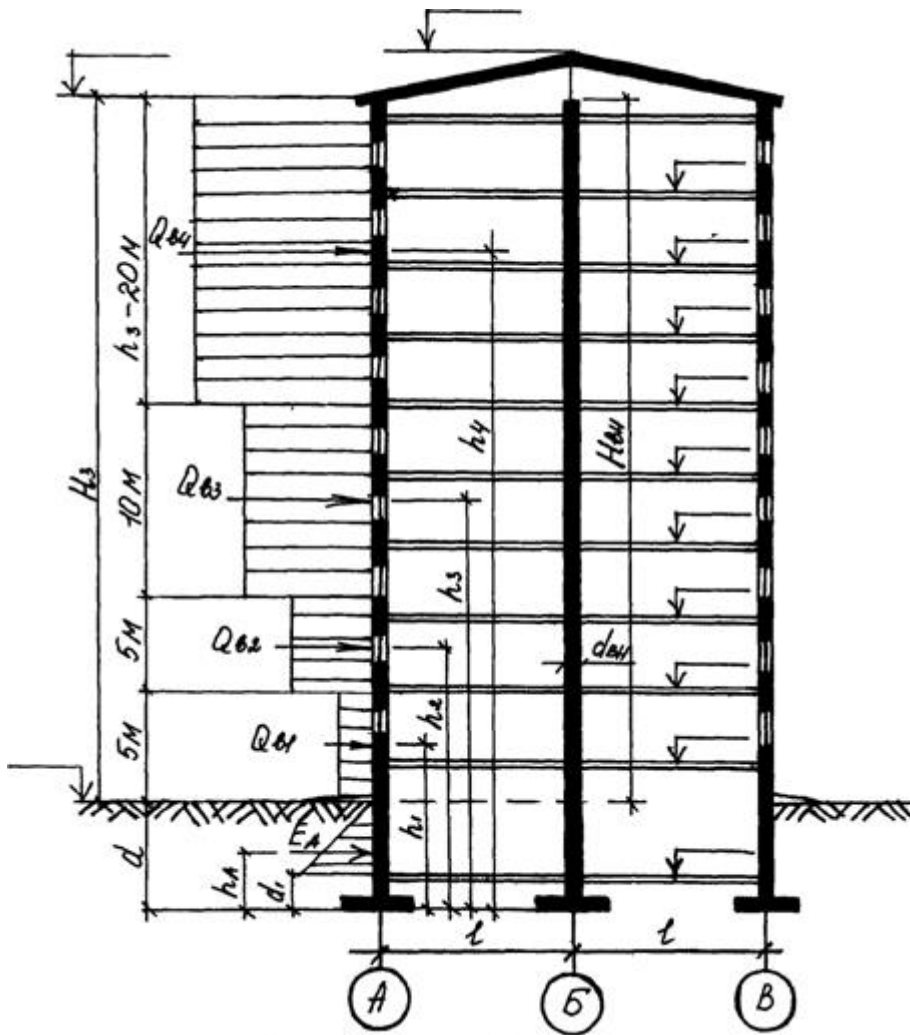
Схема до визначення навантажень на фундаменти
